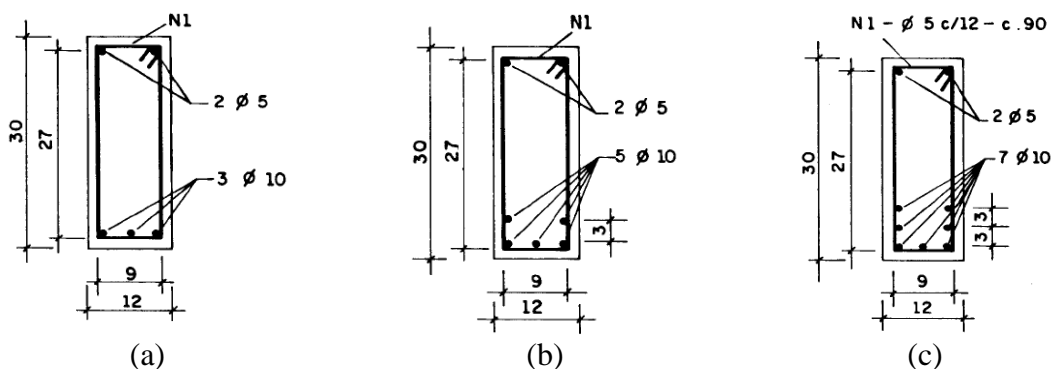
Armação das vigas de Álvares (1993): (a) pouco armada, (b) normalmente armada e (c) super-armada (ÁLVARES, 1993)
